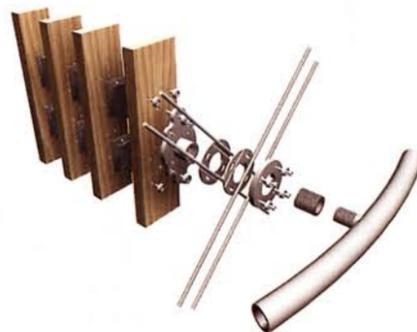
Zu den durchlaufenden Rohren bildet ein teleskopartiger Rohrverbinder mit Gegengewinden einen justierbaren Anschluss. Maßabweichungen des Holzbauteils senkrecht zur Verglasungsebene werden damit ausgeglichen.
